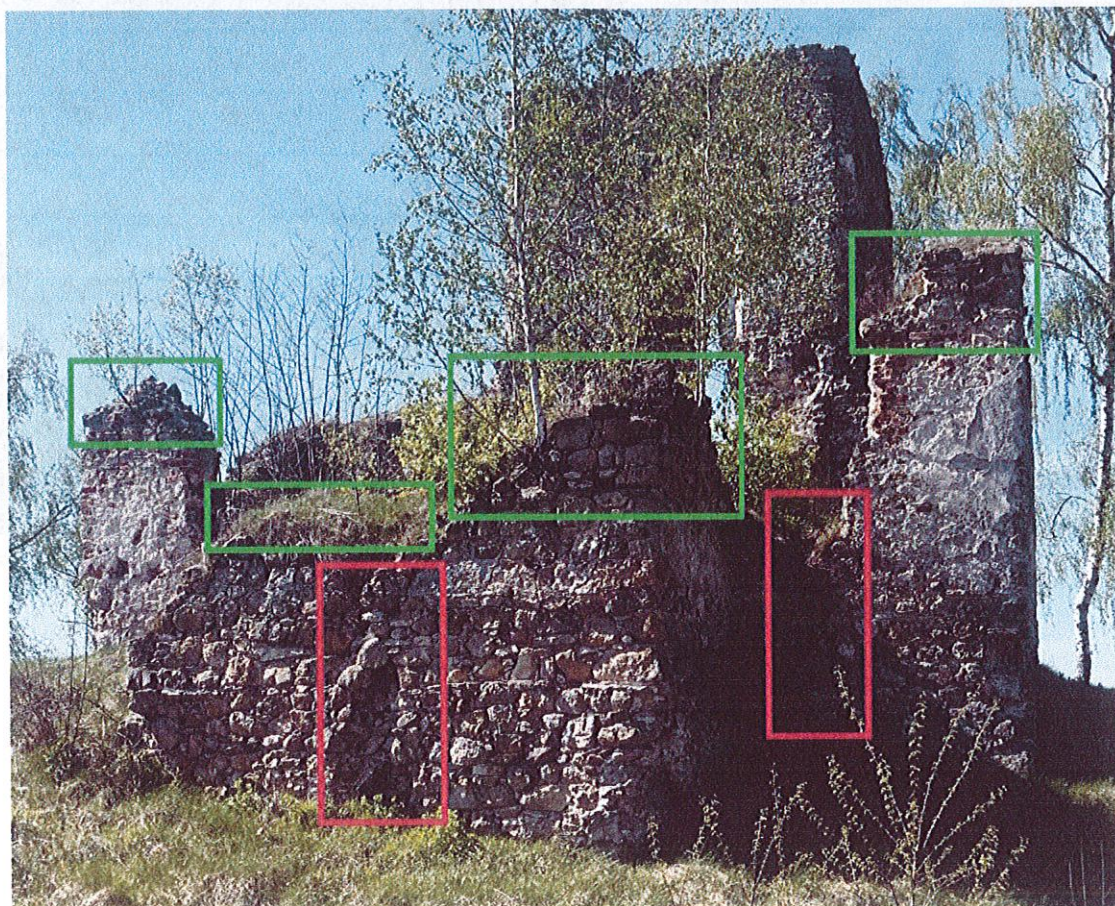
Elewacja wschodnia wieży (widok od zewnątrz). Uszkodzenia przewężenia muru (kolor czerwony). Widoczne ślady nadproża parteru wieży (kolor pomarańczowy)
